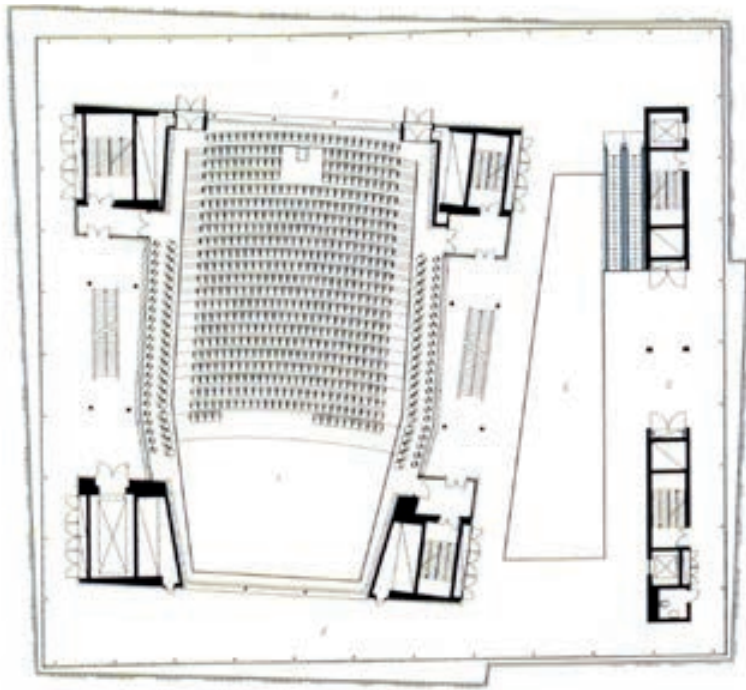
Konzert- und Kongresshalle Uppsala Grundriss
